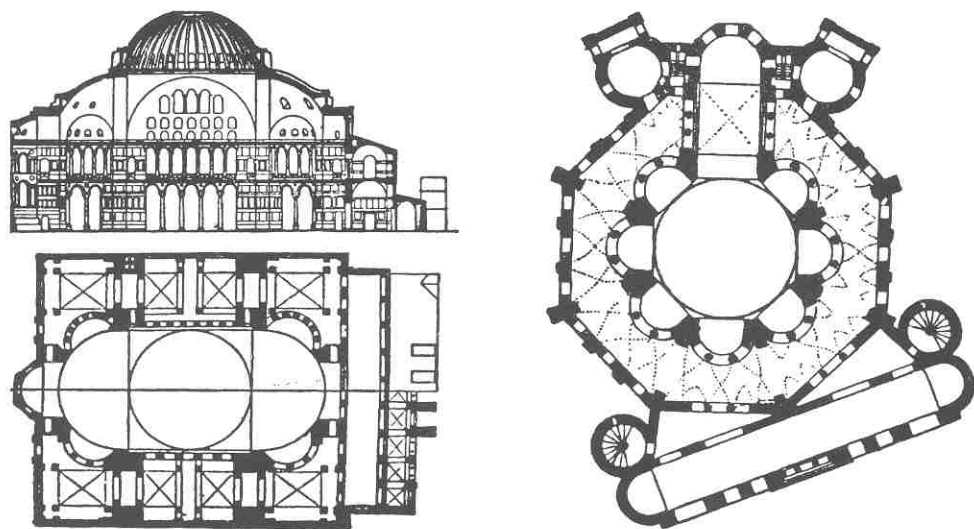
Plan et section de Sainte Sabine (achevée en 537). Plan de San Vitale (achevé en 547).
